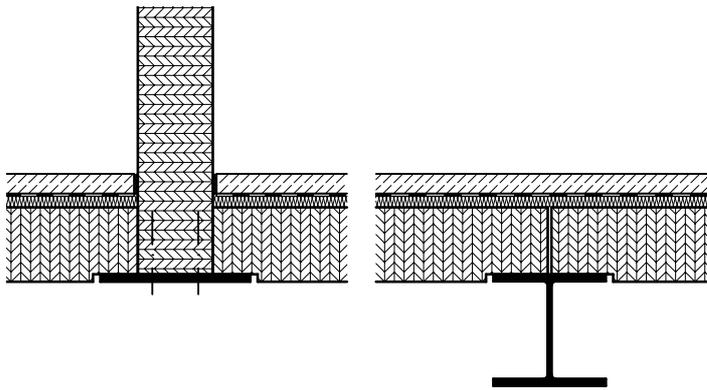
Deckenanbindung an wandartige Träger und Stahlträger
